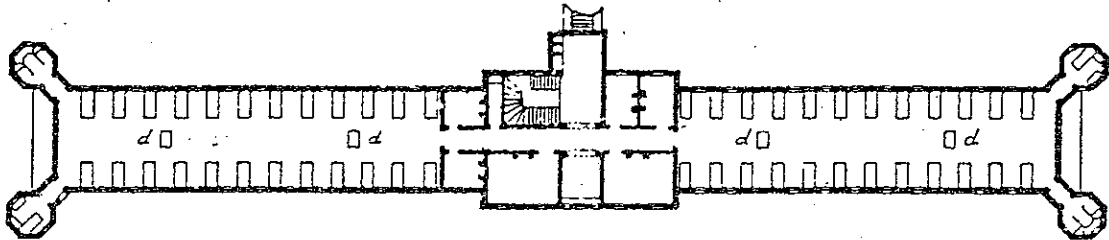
Plan des salles. — Échelle de 0,0015 p. 1 mètre.
